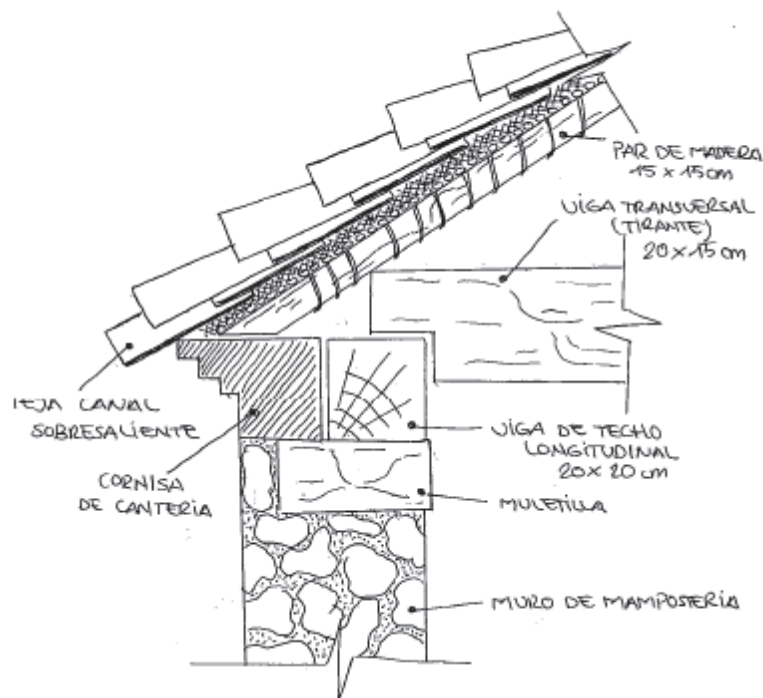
Croquis del encuentro del muro con la cubierta. 2014. M^aNieves Pujol.
